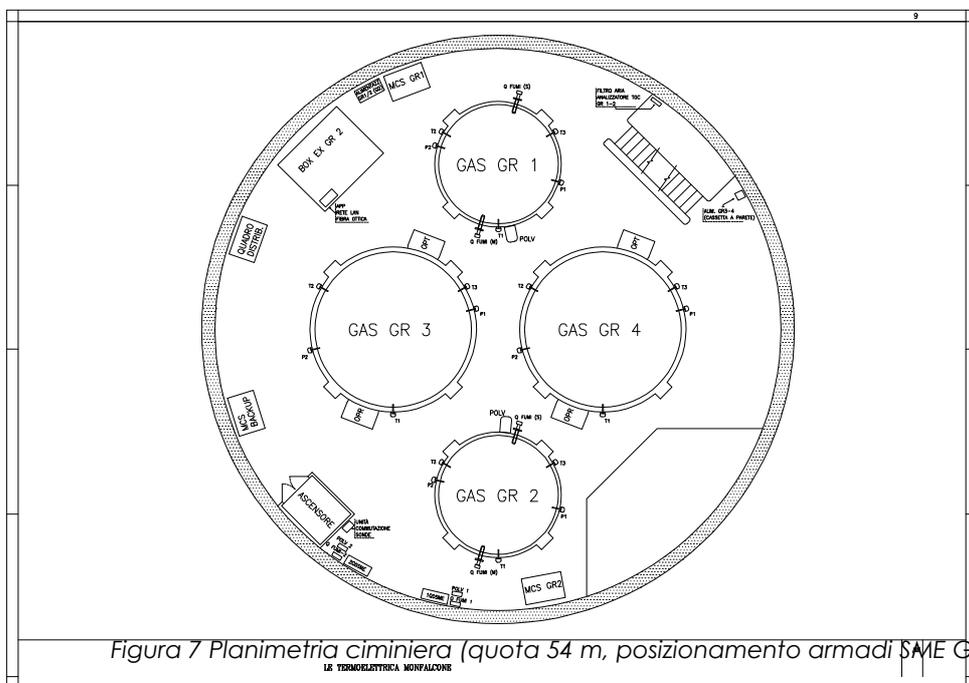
Planimetria ciminiera (quota 54 m, posizionamento armadi SME GR1, GR2, back-up e sonde prelievo)
